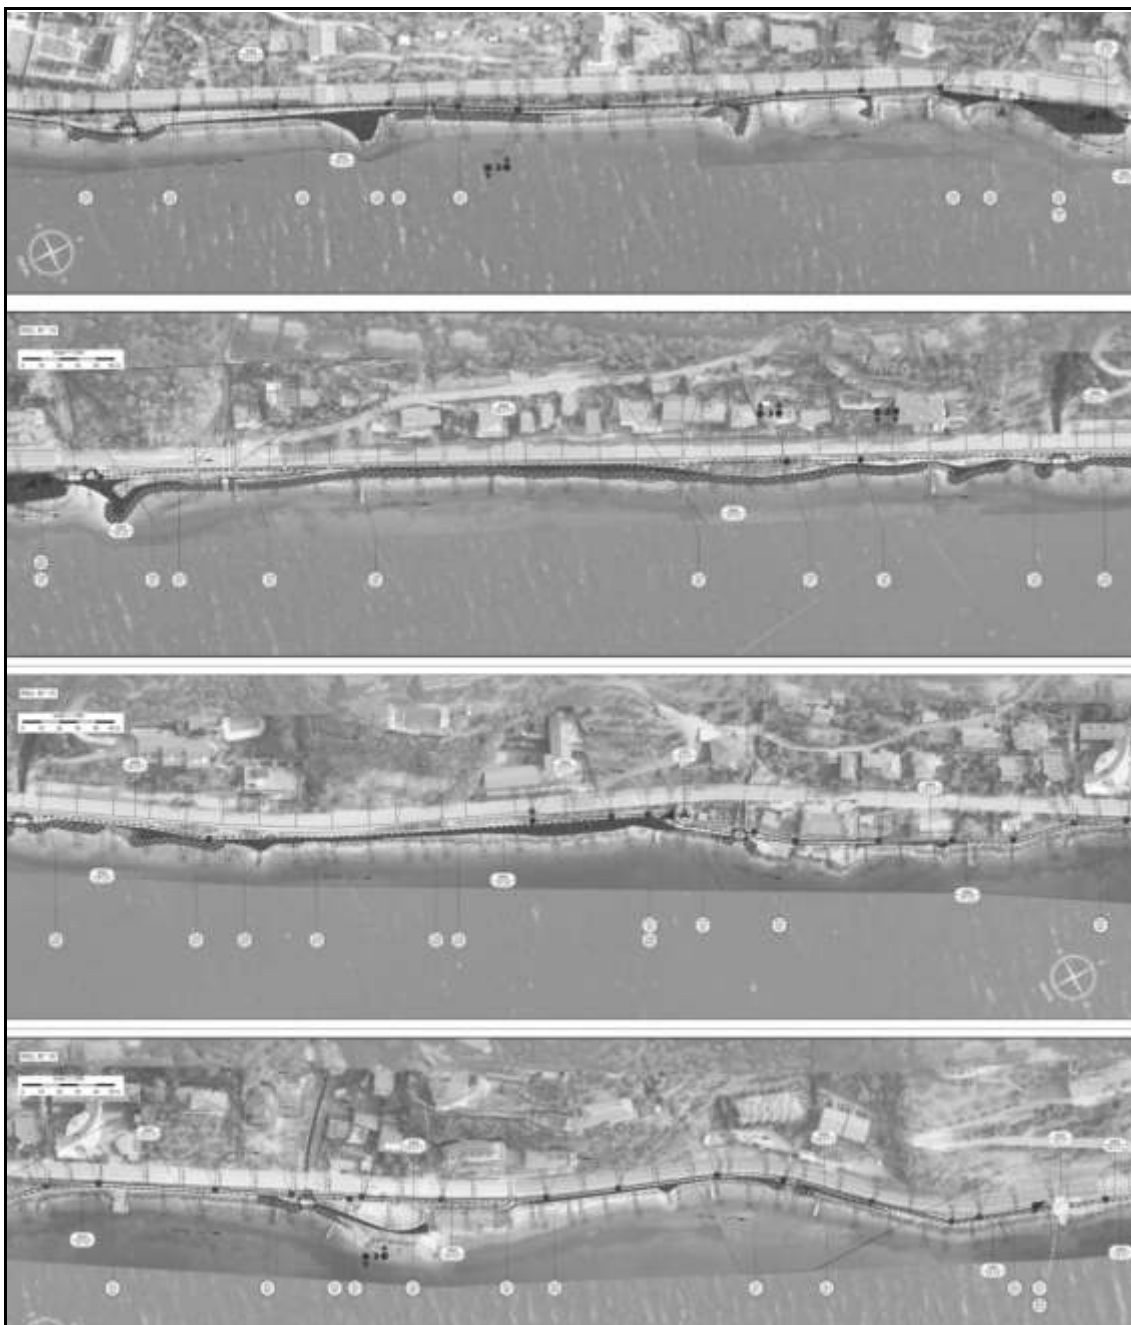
Sistemazione a scogliera in fase di realizzazione ed in progetto tra Castelletto e Pai in Comune di Brenzone sul Garda di competenza di realizzazione del progetto della pista ciclabile
